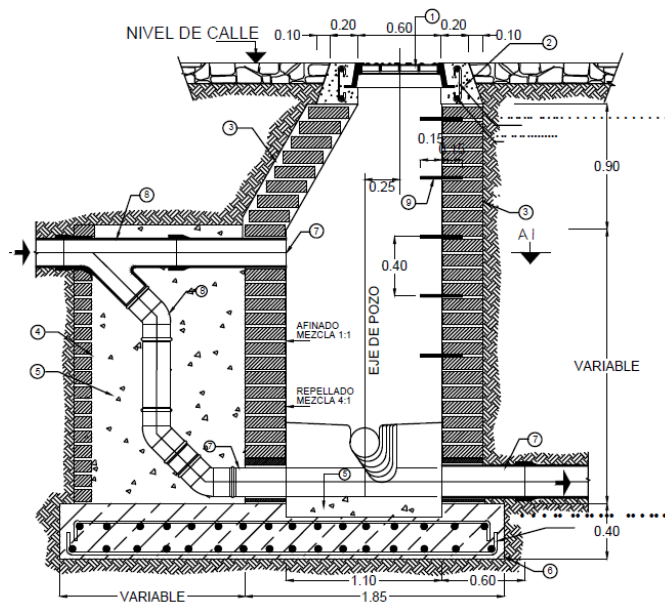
Perfil de pozo de visita con caja sostén de mampostería [Fuente: Plano tipo de ANDA].
